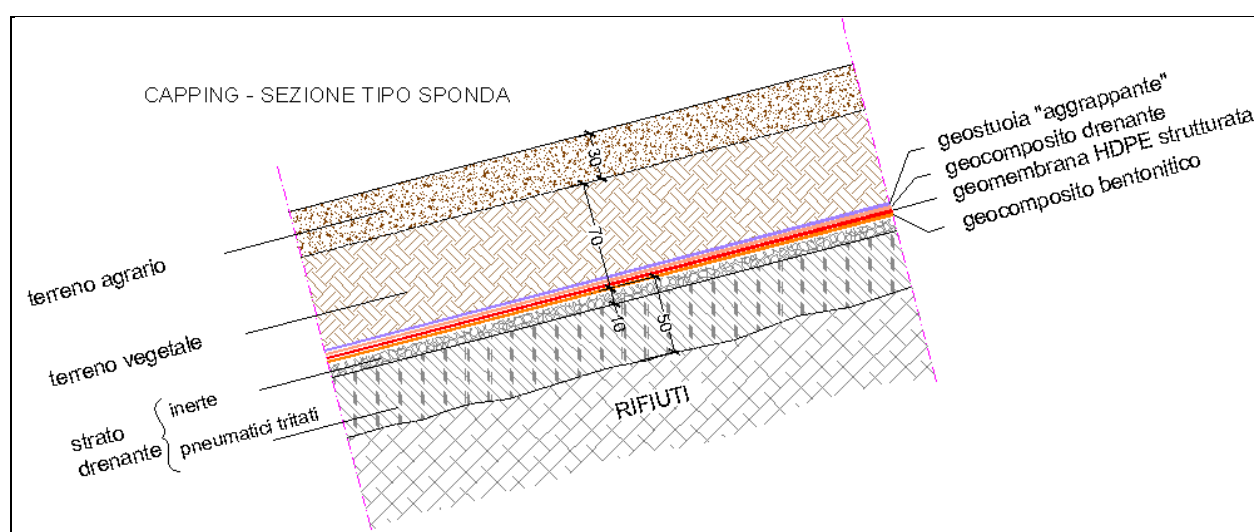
Sezione tipo, schema stratigrafico del sistema di copertura previsto per le sponde della sopraelevazione in progetto
